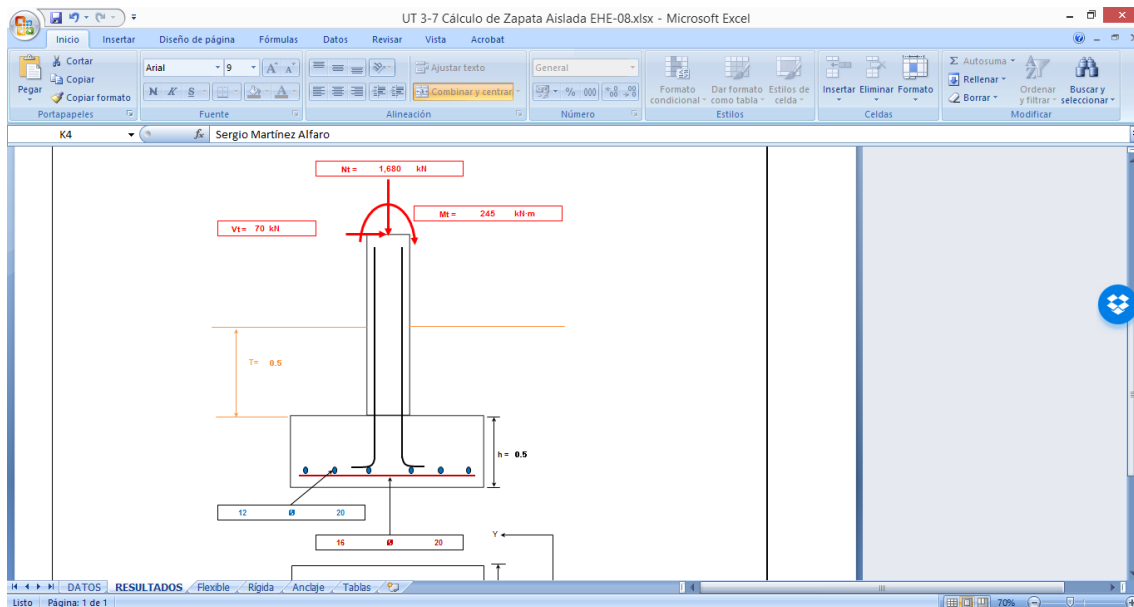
Detalle de la aplicación elaborada por un alumno de la asignatura, donde se observa la hoja donde la aplicación realiza los cálculos de la armadura inferior a flexión en el caso de que la zapata sea flexible
